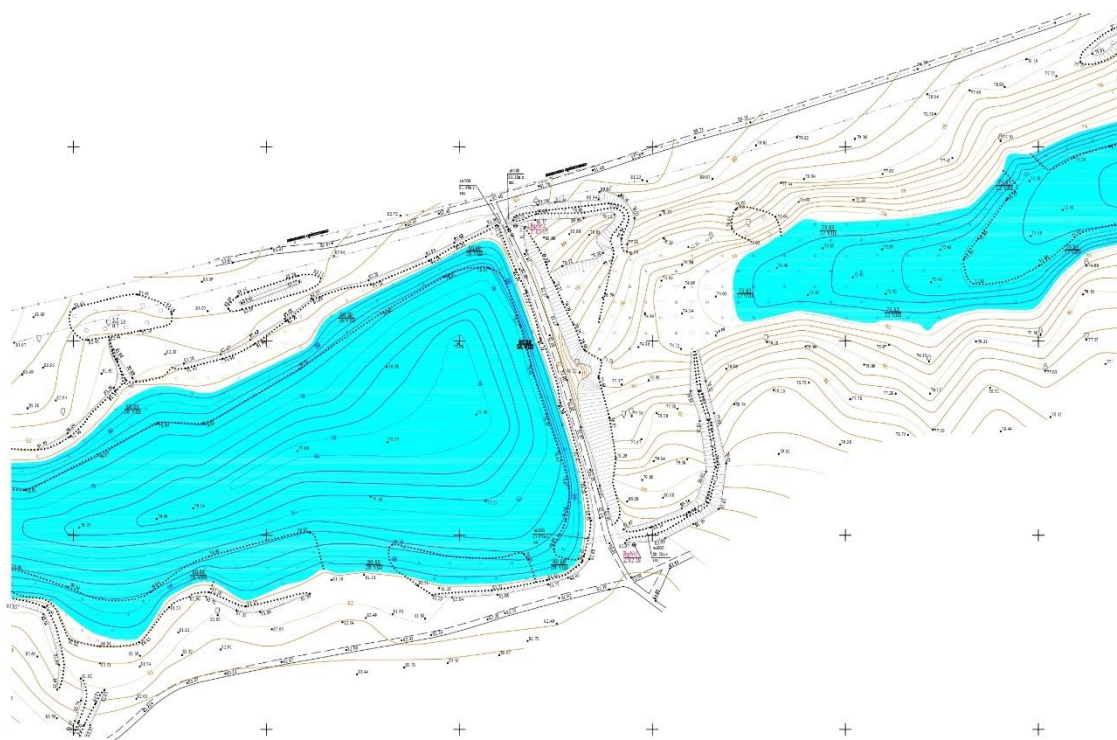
План масштабу 1:500 водойми у с. Вільне
